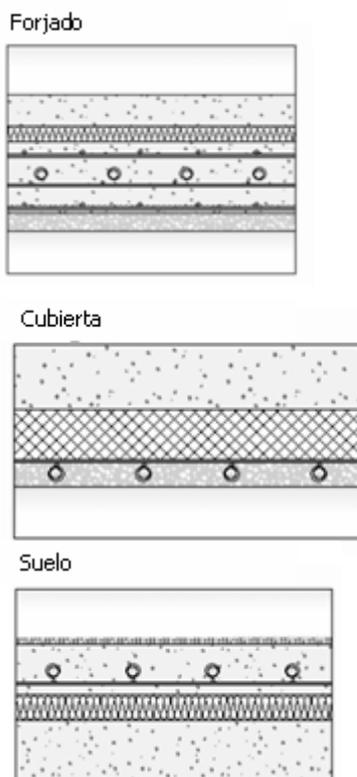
Conductos embebidos en forjado, cubierta y suelo
